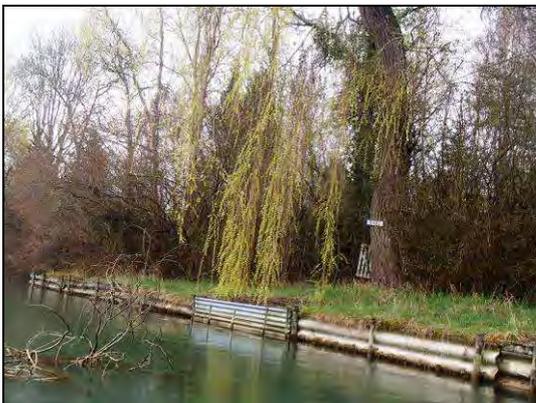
Palplanches métalliques sur le bras de Balloy (11/04/2013)
